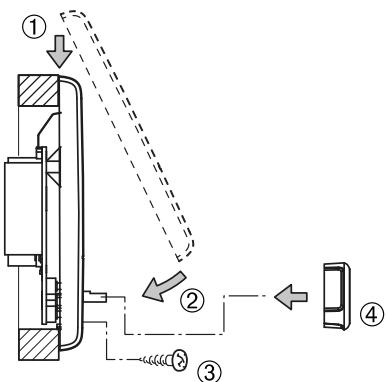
Monter la partie supérieure de pièce de commande et le bouton rotatif/poussoir
